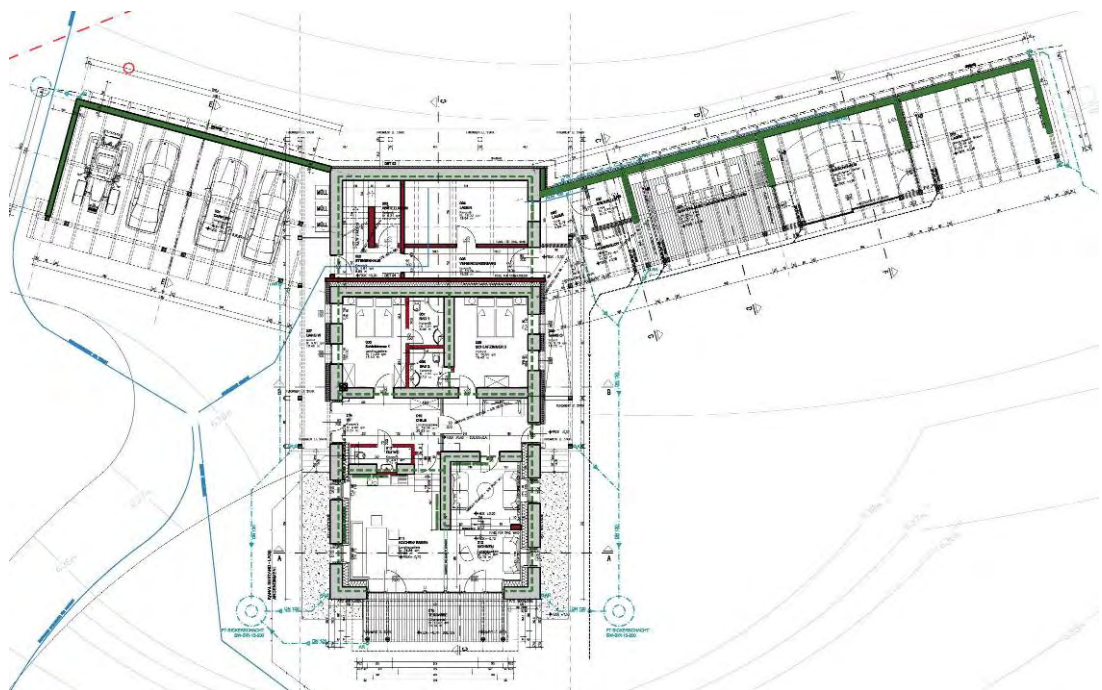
Grundriss Erdgeschoss (Carport, Energie Plus Haus Weber, Glashaus)
